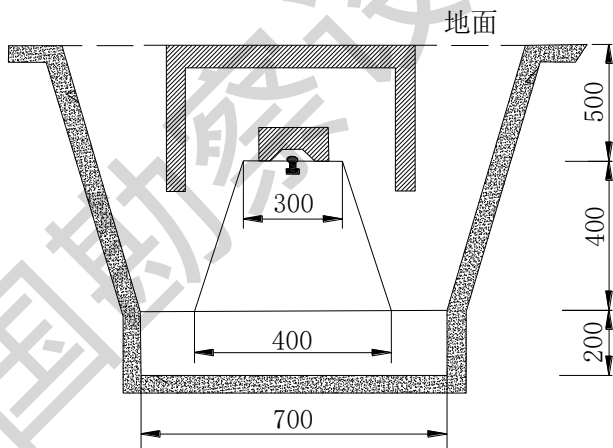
混凝土普通水准基准点标石（单位：mm）
